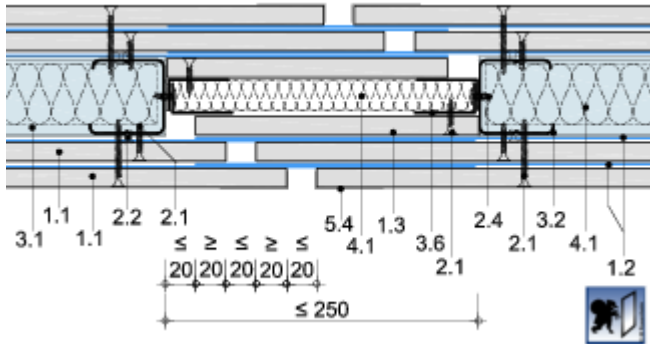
Trennwandanschluss Doppelständerwand RC 3 mit erhöhtem Schallschutz
